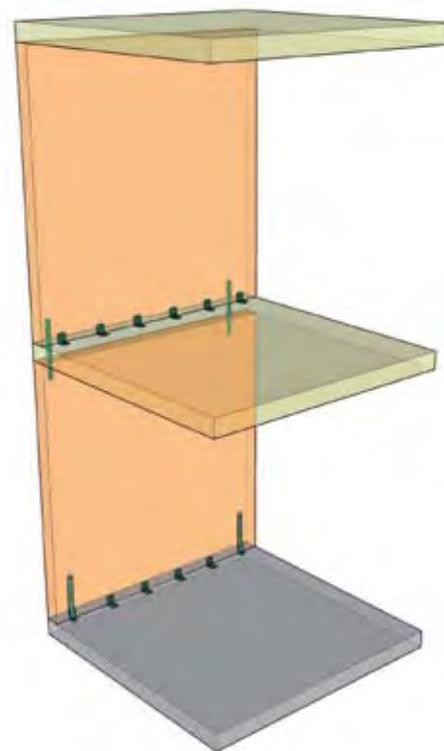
Distribuzione forze da solaio a pareti a fondazione
